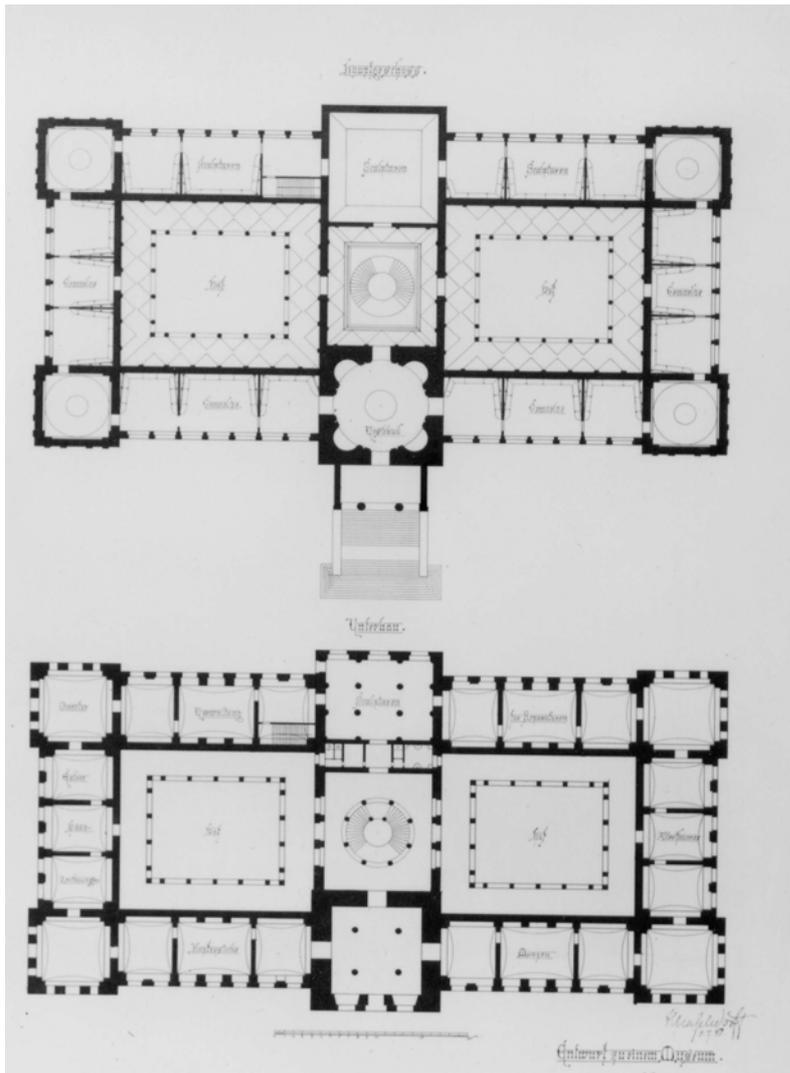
Heinrich Plange, Entwurf zu einem Museum, Grundriss Hauptgeschoss (oben) und Unterbau (unten), 1880
